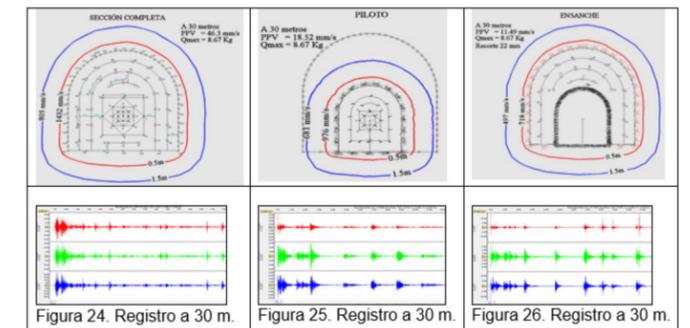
, 25 y 26. Registro de vibraciones a 30 m de la voladura para el caso de un túnel excavado a sección completa; con galería piloto, y en ensanche
